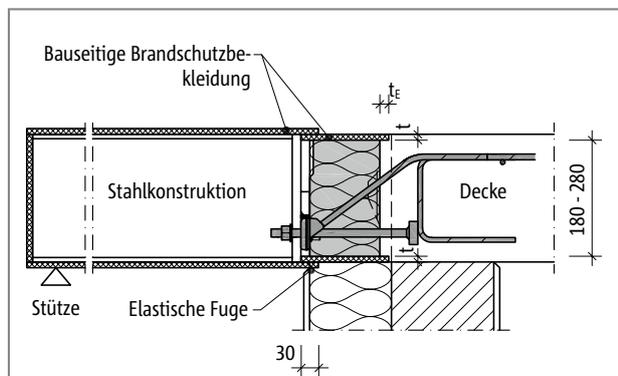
Schöck Isokorb® XT Typ SQ: Bauseitige Brandschutzbekleidung für den Isokorb® und Stahlkonstruktion; Schnitt
